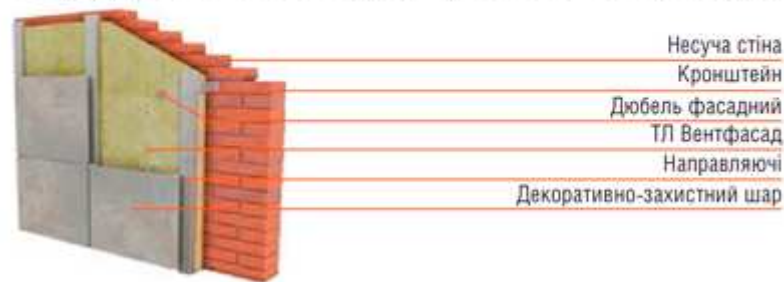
вентиляований фасад від ТМ «Термолайф»
